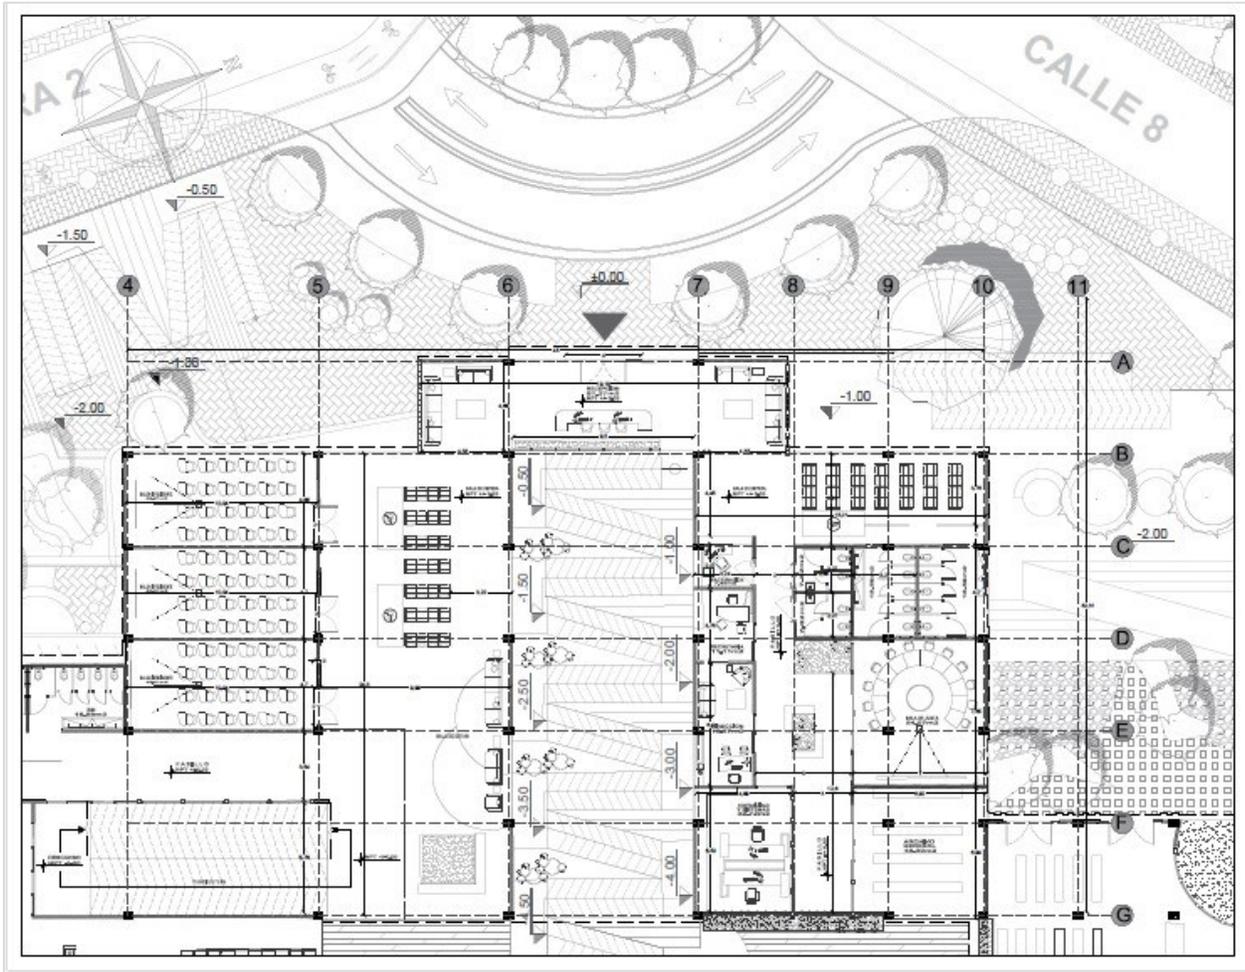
Planta 0 Edificación 1 (Rubiano, 2020)
